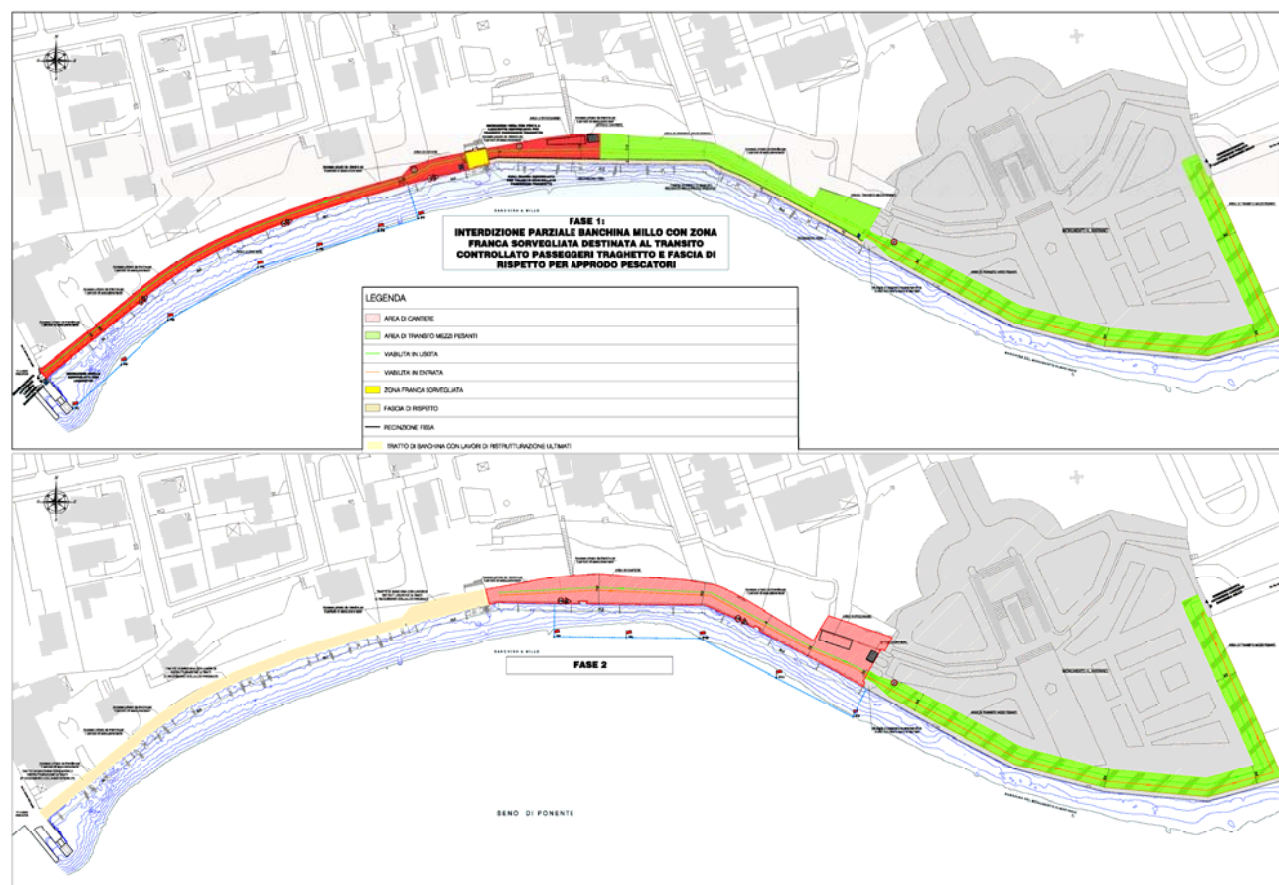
Fase 1 e fase 2 della soluzione di cantierizzazione proposta
